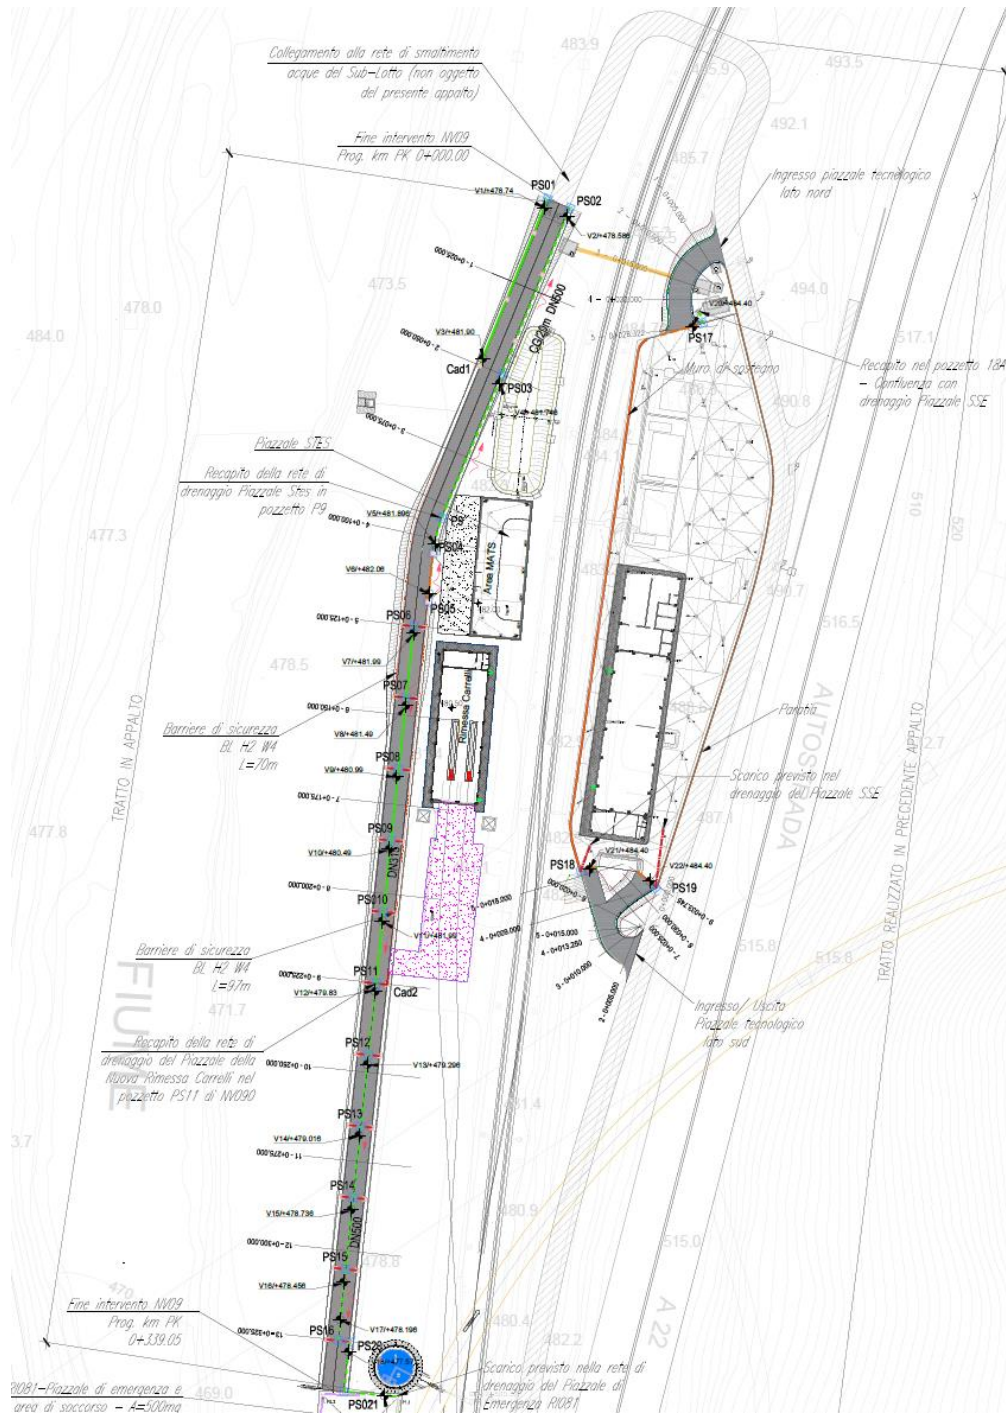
Planimetria idraulica di progtto NV090 II Tratto
